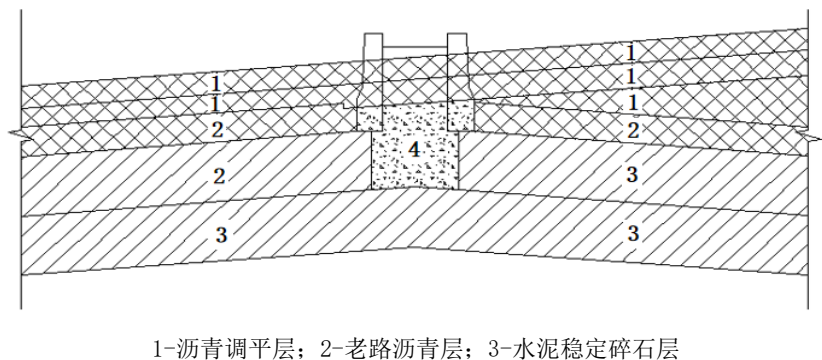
中分带拆除改造素混凝土填平路面拼接构造示意图
